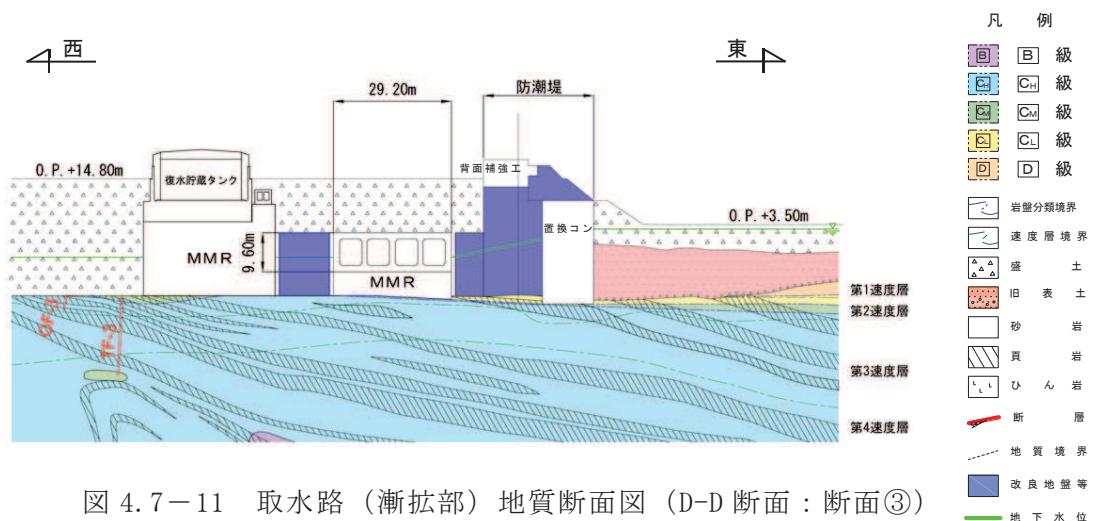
取水路（漸拡部）地質断面図（D-D 断面：断面③）
